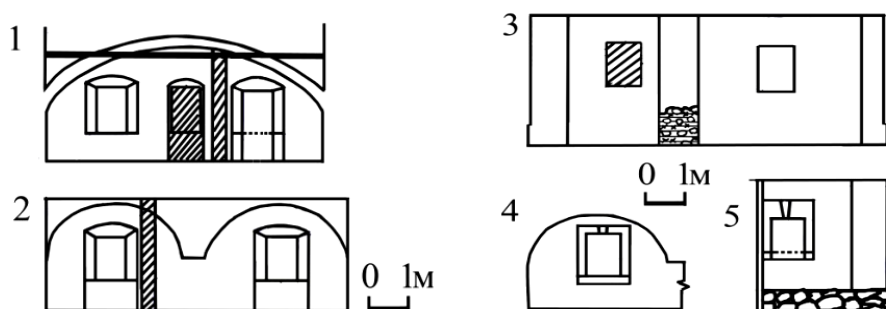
Фиксационные планы стен и фасадов пекарни:
